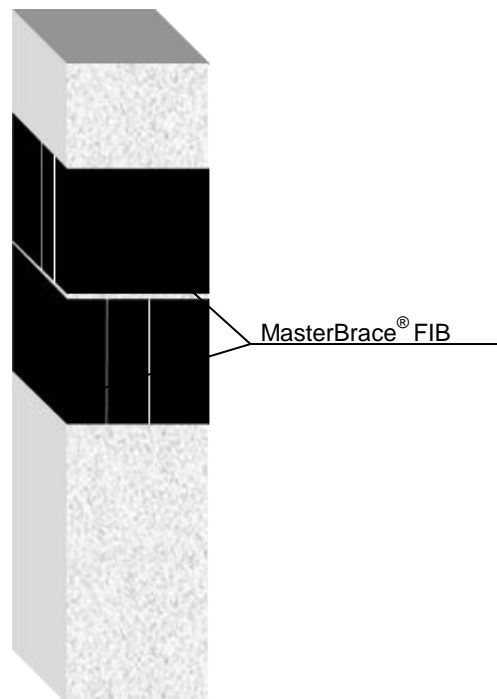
Refuerzo con MasterBrace® FIB Pilares Prismáticos
